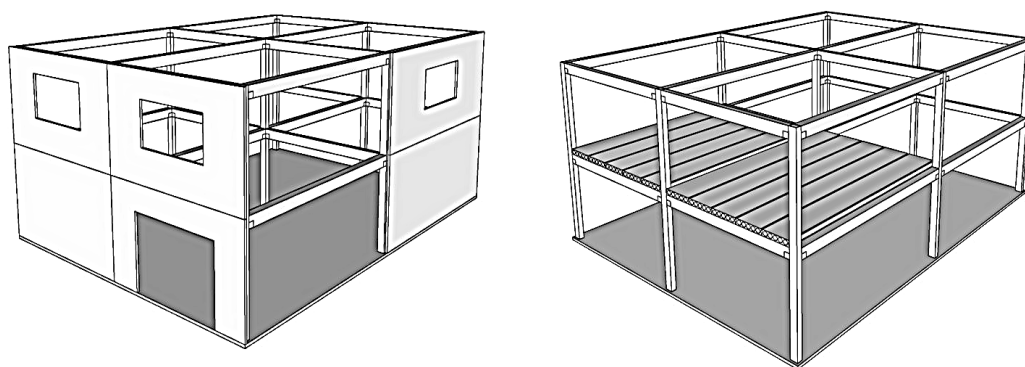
Exemplos de estrutura e vedação pré-fabricadas
